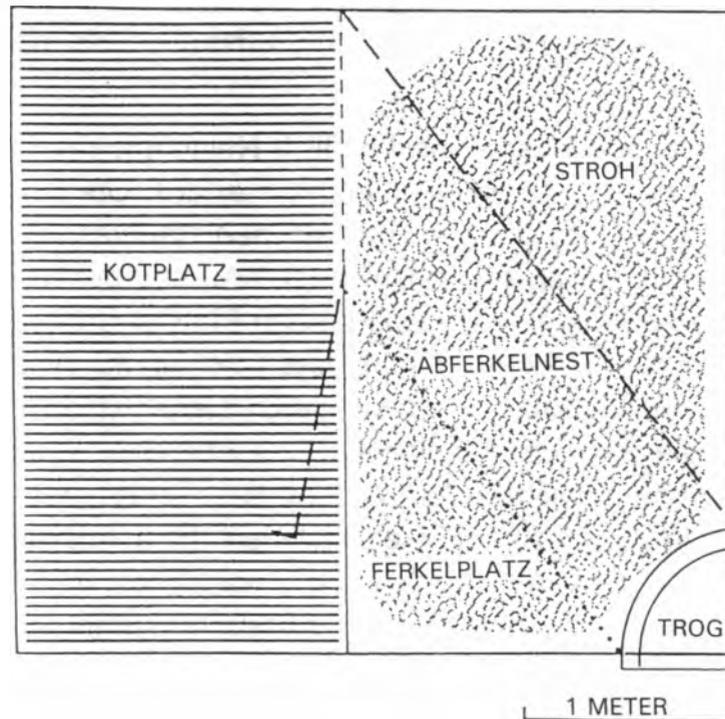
Grundriß einer Einzelabferkelbucht mit Langstroh auf der Liegefläche und mit Betonspaltenboden im Kotgang.
